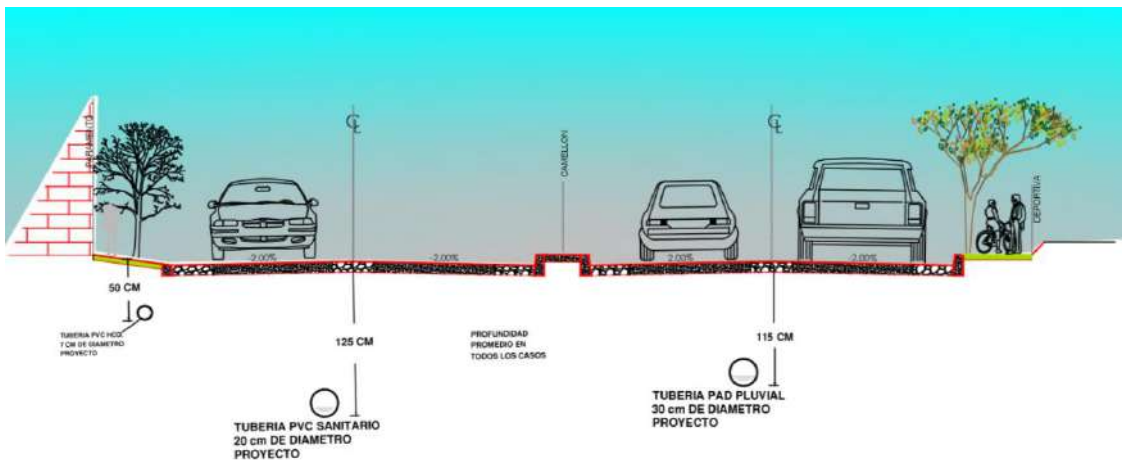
Red de drenaje pluvial, corte de calle. Planos de drenaje pluvial de la calle.
